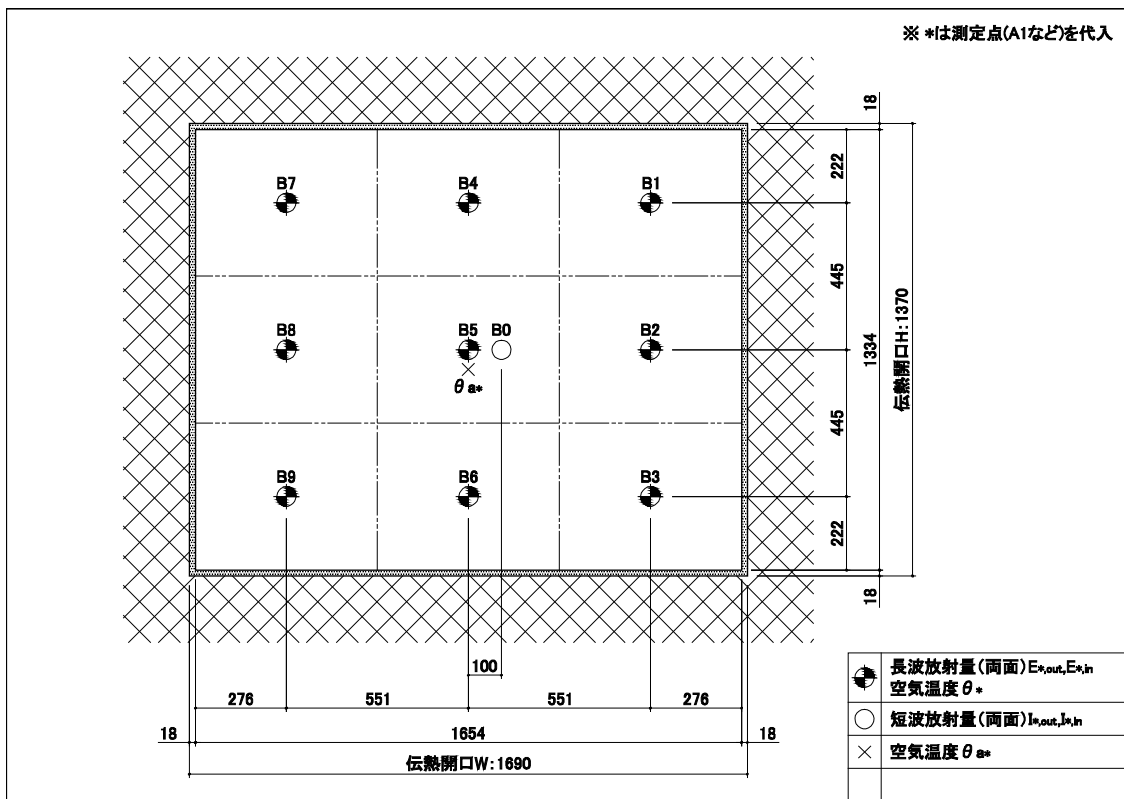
センサー配置図 (中空, Section B, ※内観を示す)
